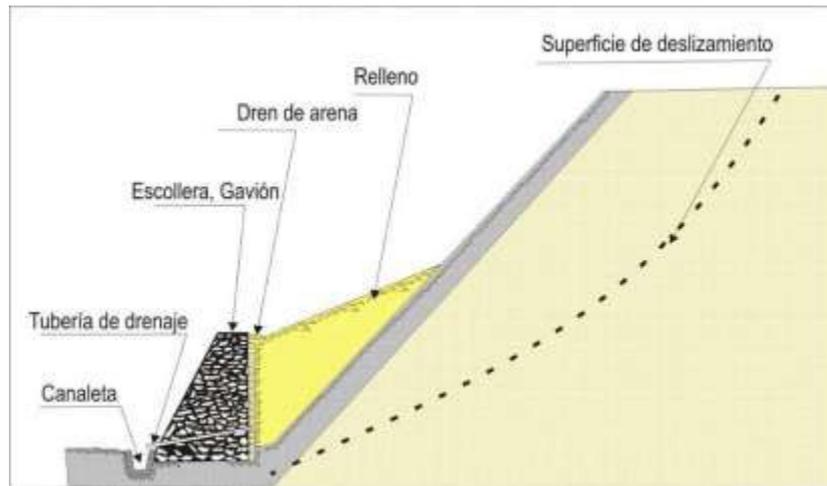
Muro permeable al pie del talud de una zona con deslizamiento.
